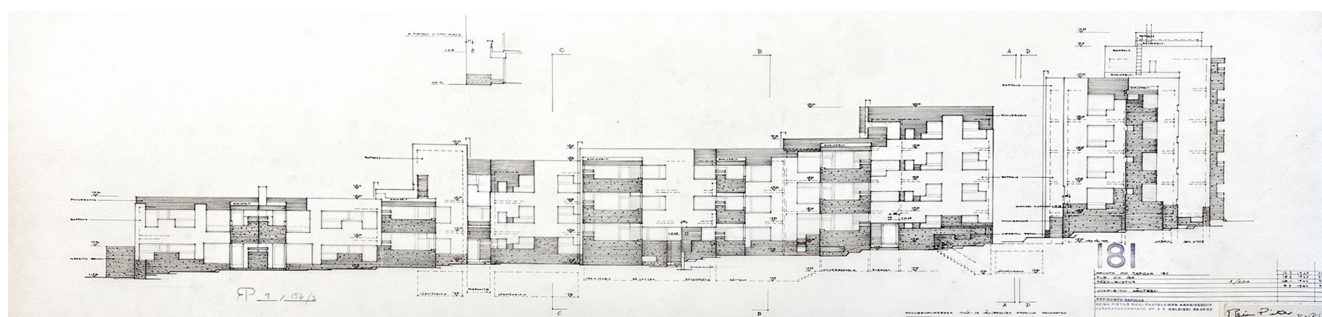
Alzados oeste del conjunto residencial Suvikumpu. Bloque 181. Ref. 9/156/2. [Fuente: MFA]
